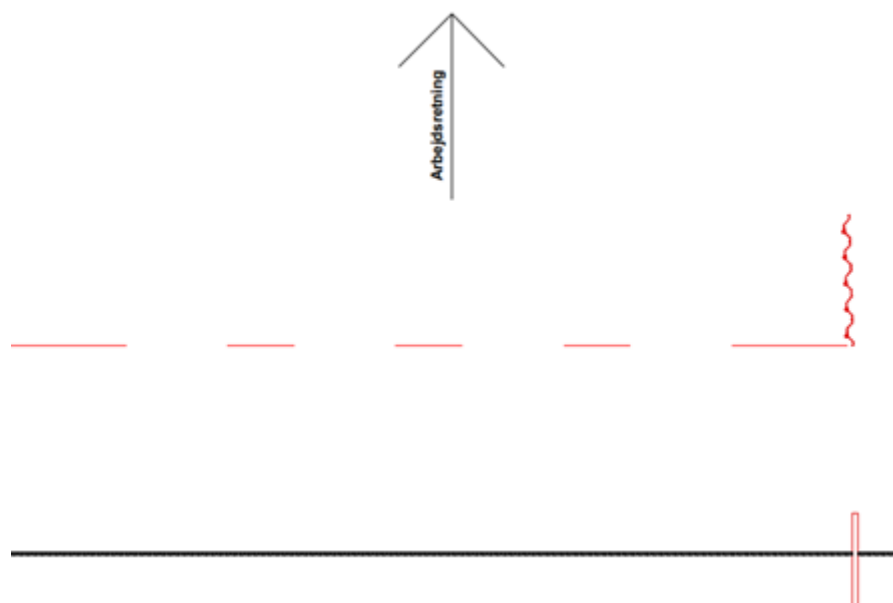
Fase 5: Dæmningsopbygning (overside fald på elementer er ikke vist).
